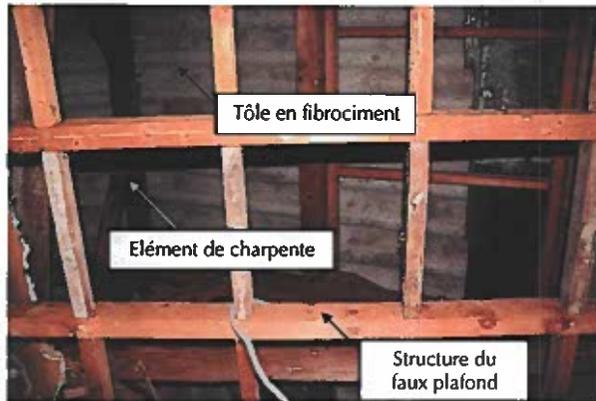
Tôles en fibrociment reprises par la charpente bois, structure du faux plafond, photo SASU Atelier Cord
